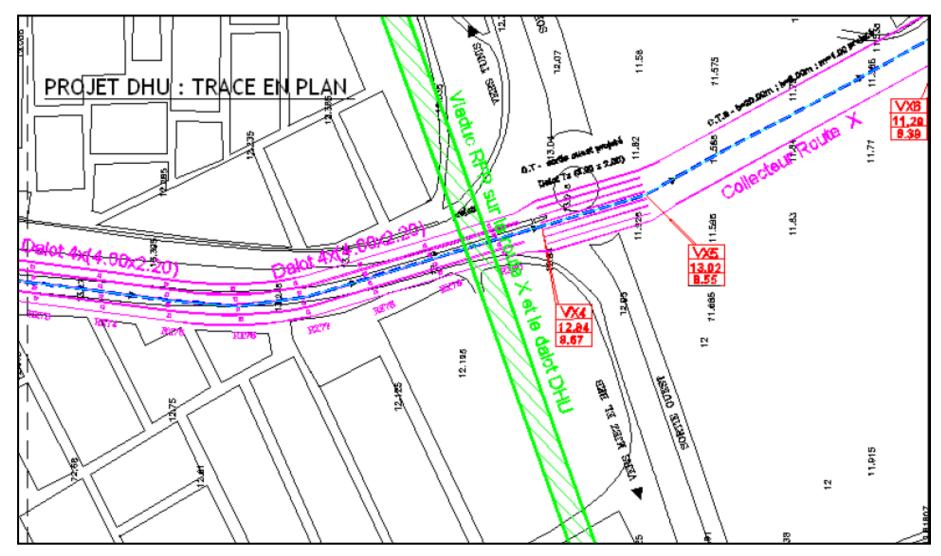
Schéma du futur collecteur des eaux pluvialex dans le site d'implantation du viaduc (protection contre les inondations du Grand Tunis, DHU).
